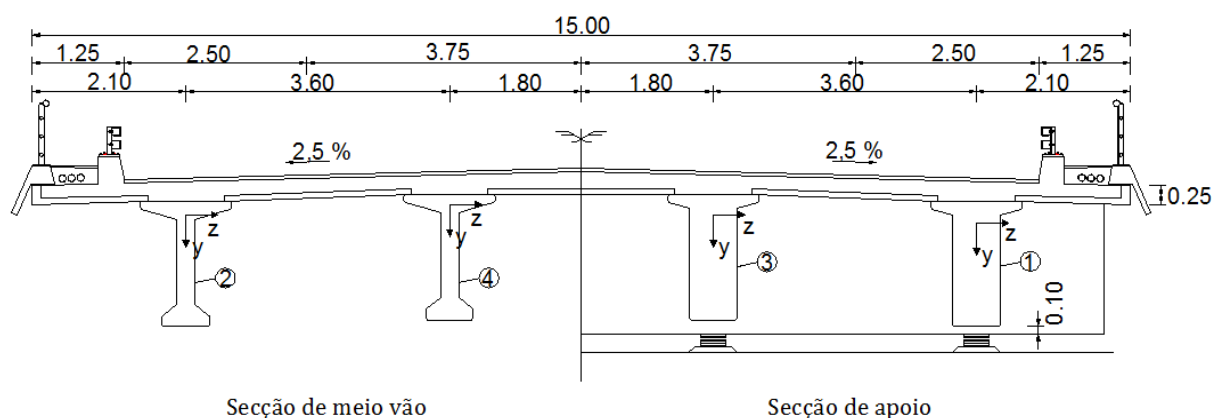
Secção transversal do tabuleiro do caso de estudo 5.
